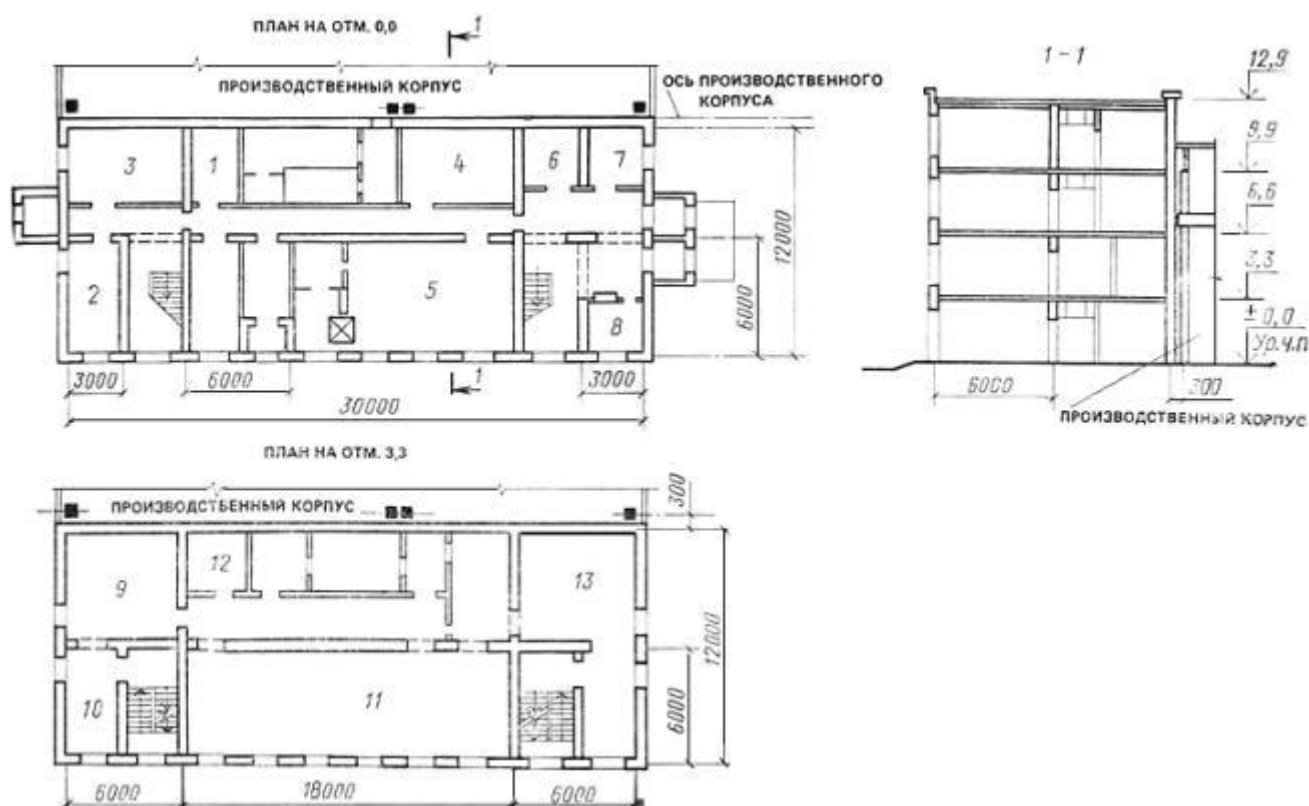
Главный корпус. Пристройка административно-бытовых помещений
